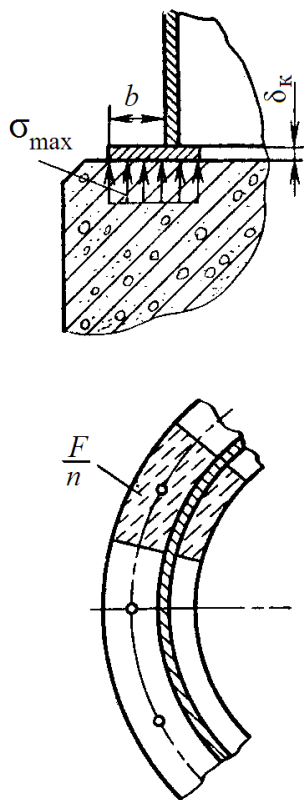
Схема к расчету нагрузки на фундаментное кольцо
